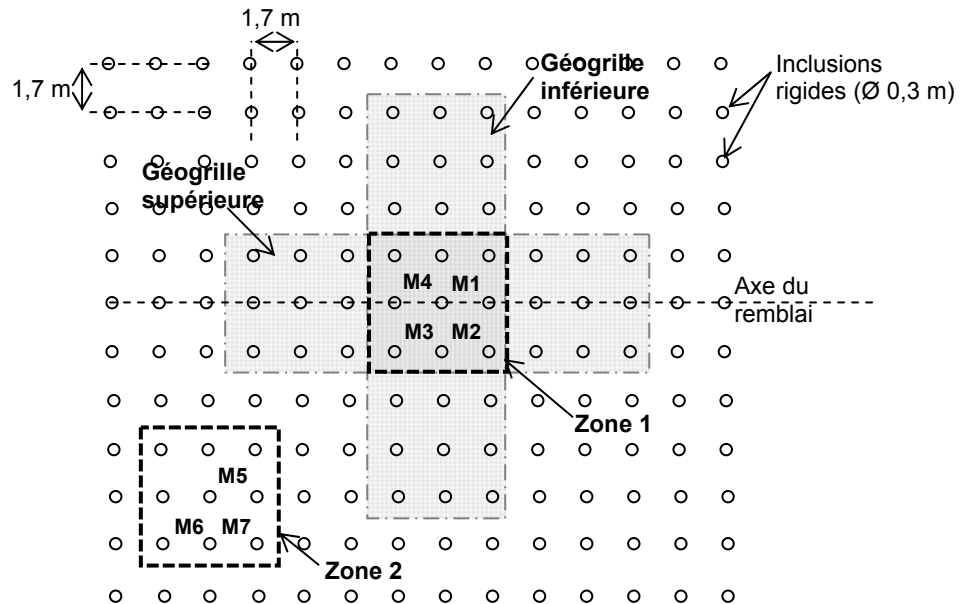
Vue en plan des zones et mailles instrumentées
